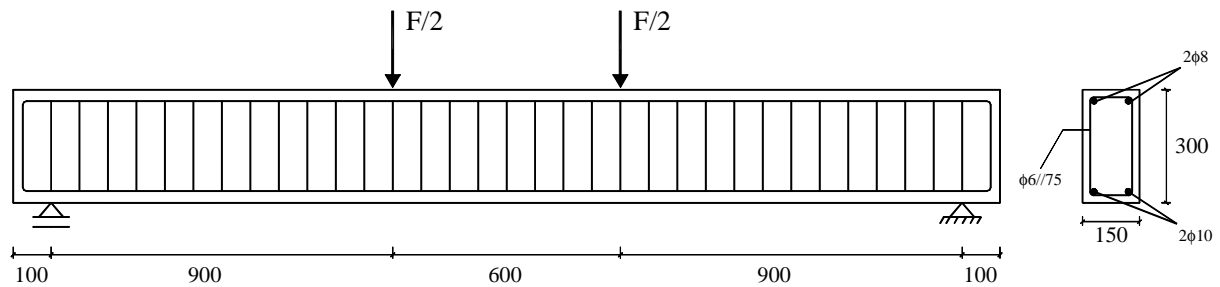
Geometria, tipo de ensaio e armaduras de aço comuns a todas as vigas ensaiadas (dimensões em mm).
